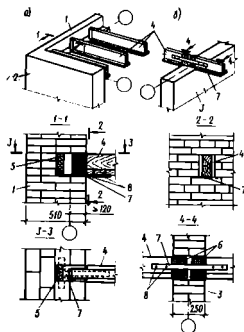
Детали опирания деревянных балок перекрытий на каменную стену:
